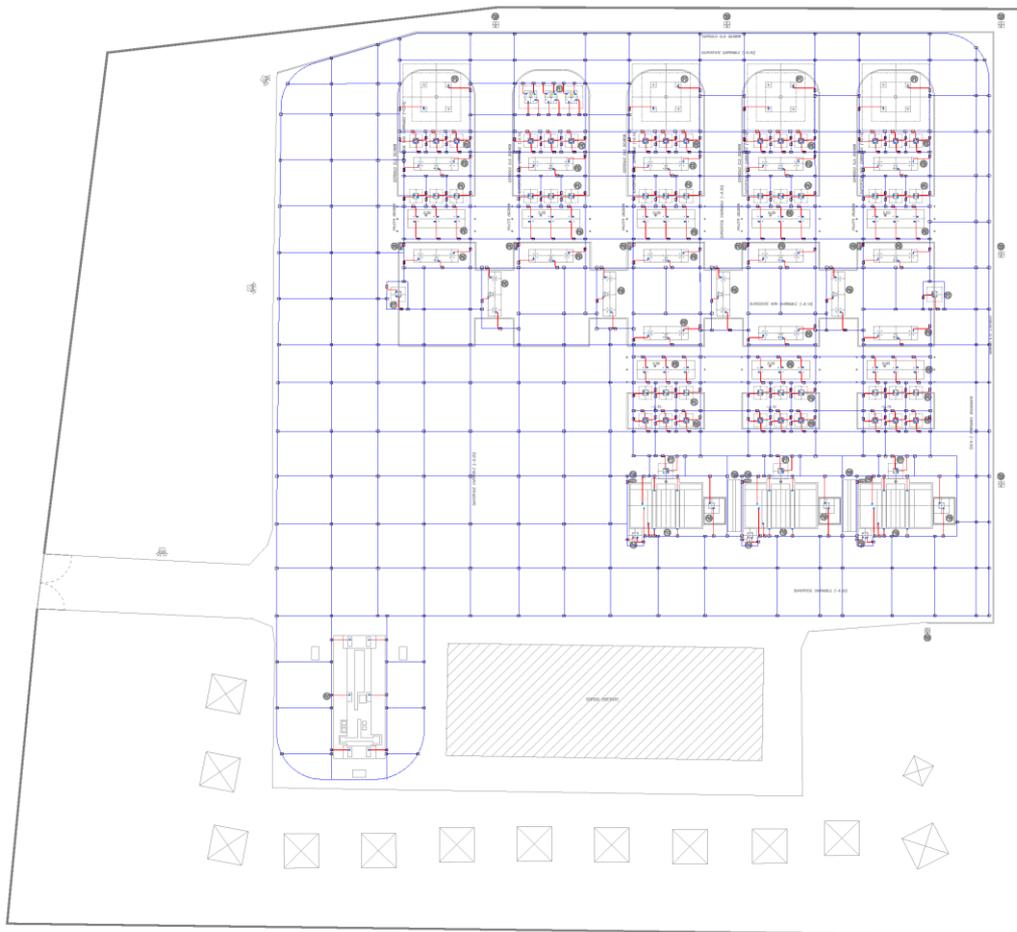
Stralcio planimetrico rete di terra cabina primaria Venosa
